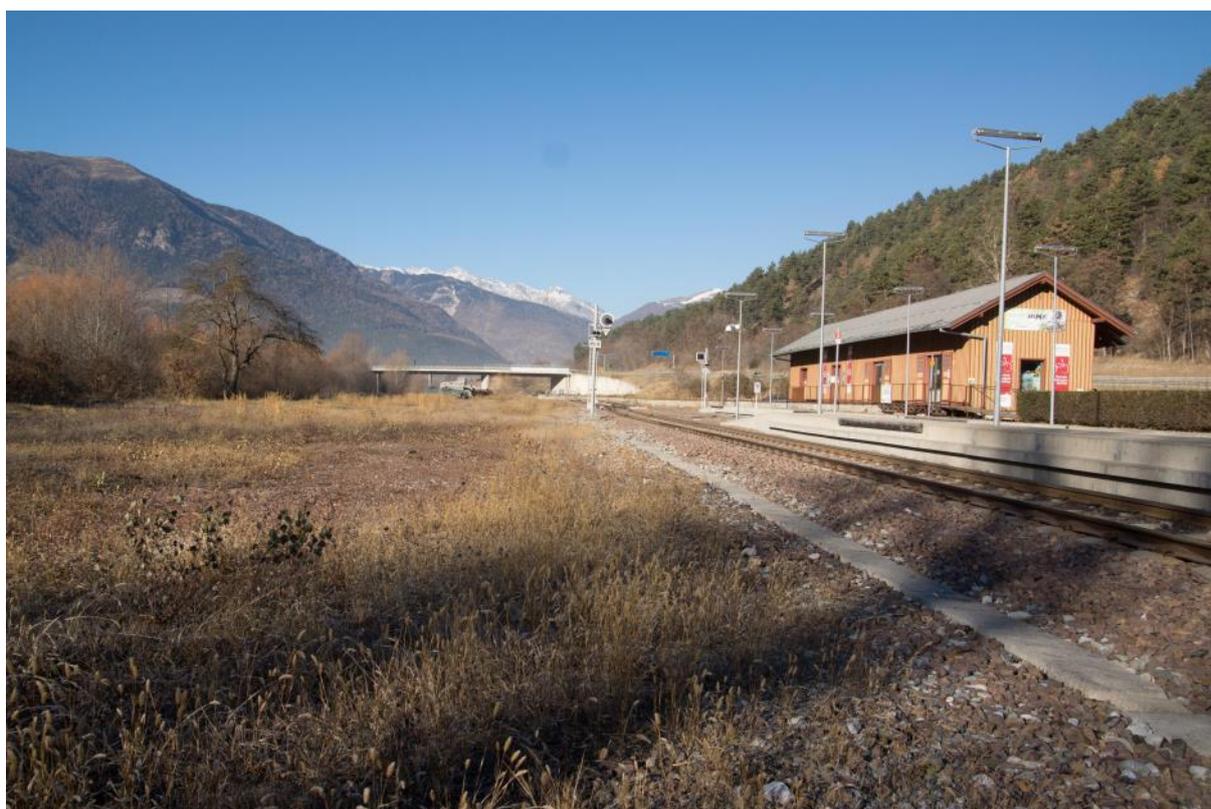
Die aktuelle Brachfläche am Bahnhof wird bis zur Brücke im Hintergrund als Baustellenfläche verwendet.
